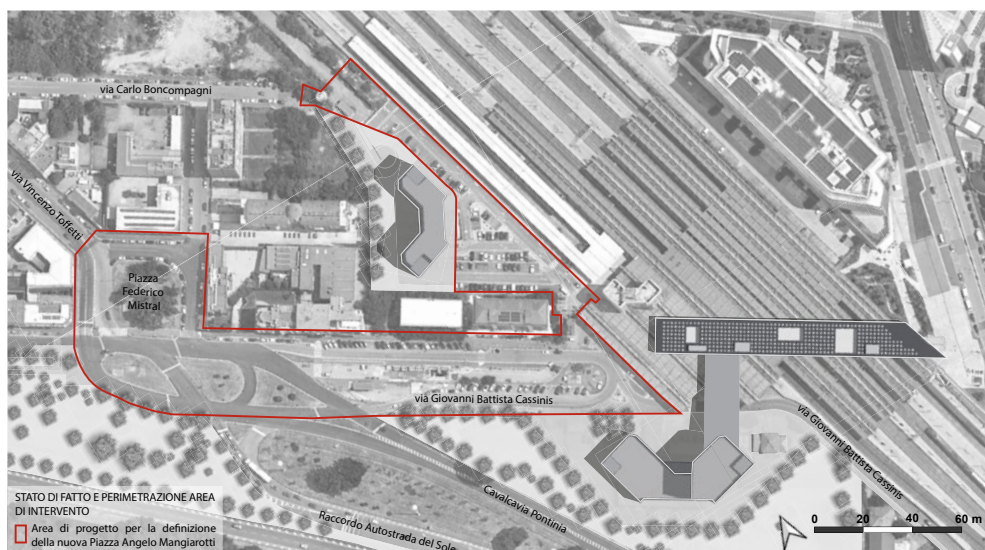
Stato di fatto con perimetrazione dell'area di intervento.
